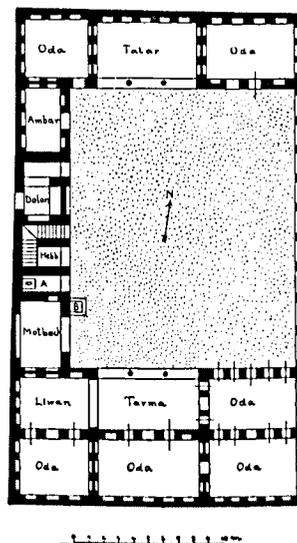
Haus des Sejid Abdallah, Vorstadt am Bab el Muadam; Bagdad. Grundriß.
